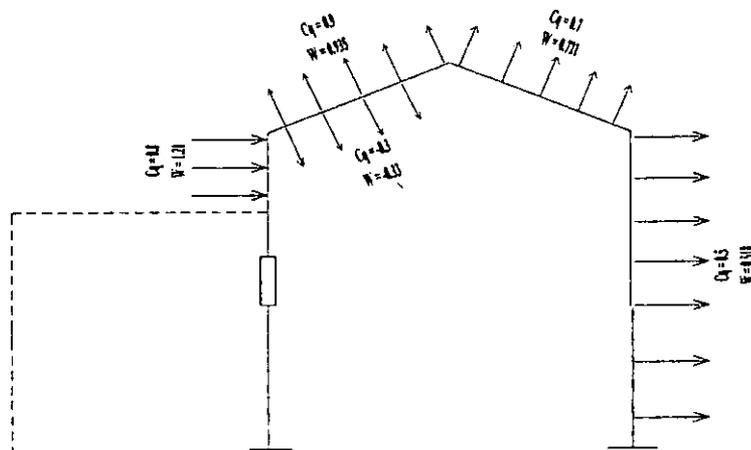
VIENTO TRANSVERSAL SUR-NORTE
